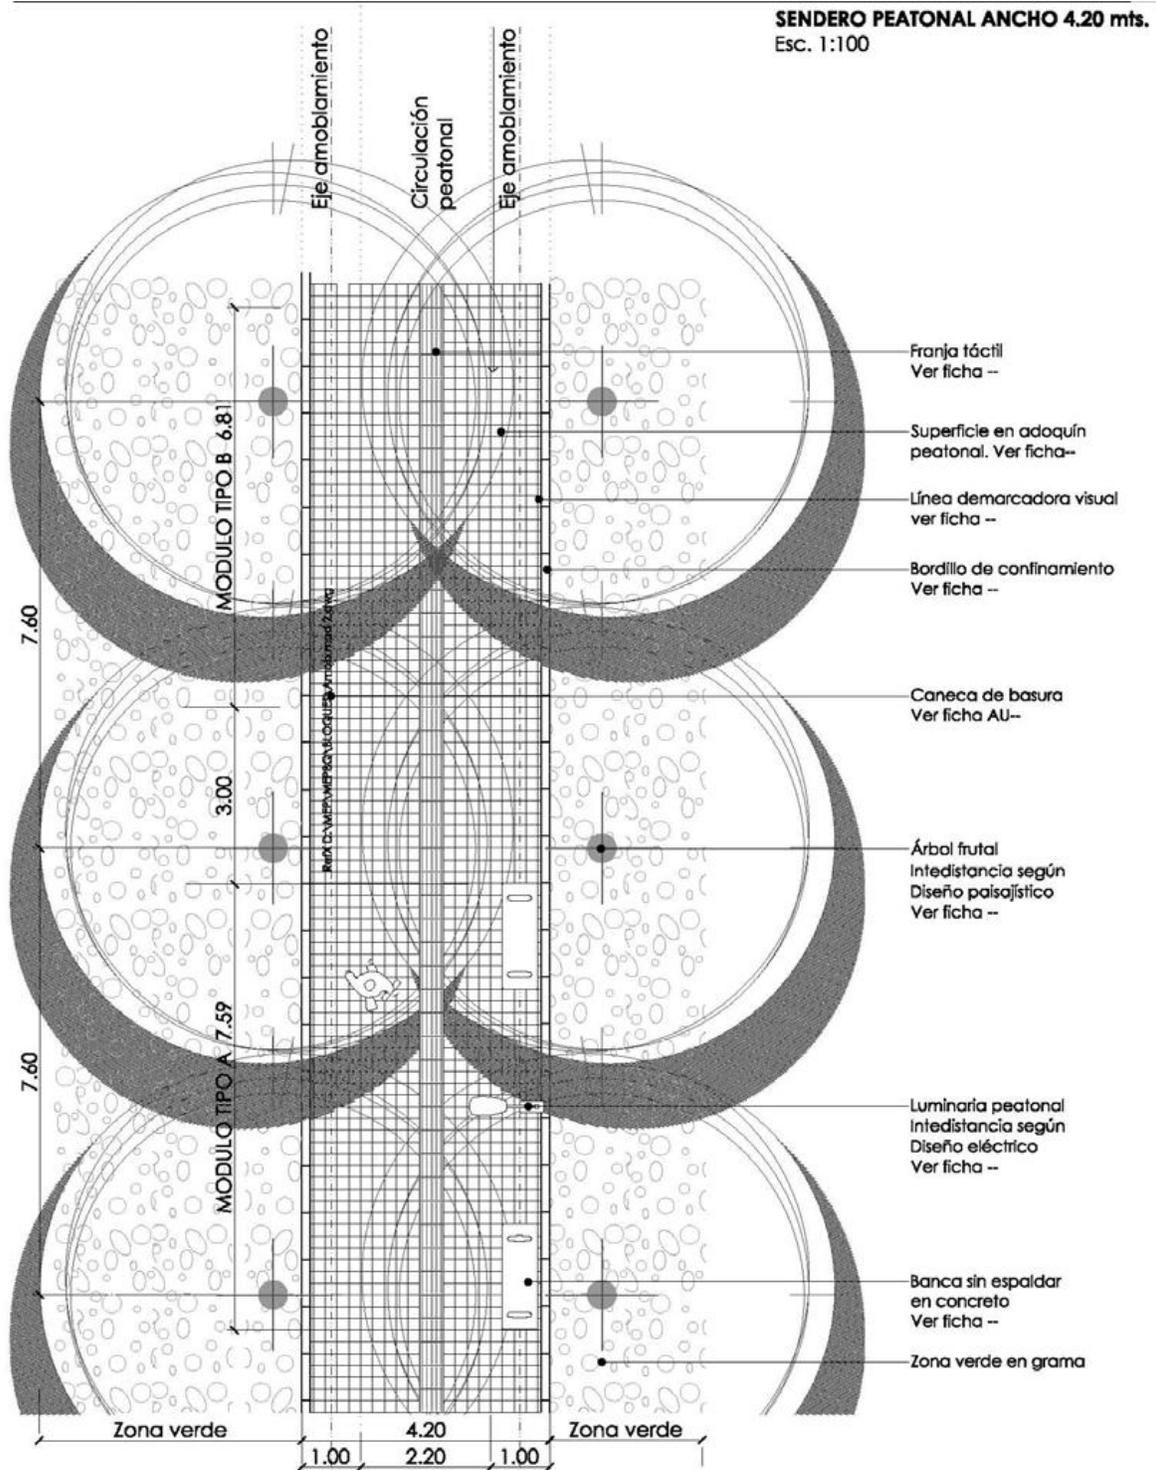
Planta Sendero Peatonal ancho 4.20 m
